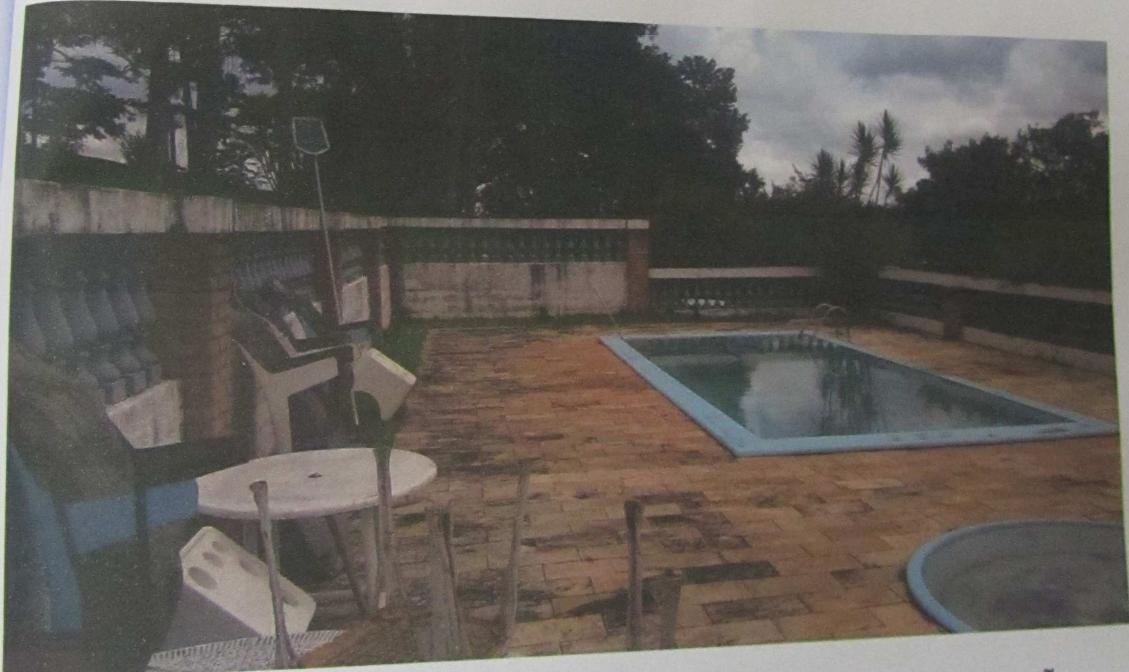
Vista das piscinas, ambas em mau estado de conservação
